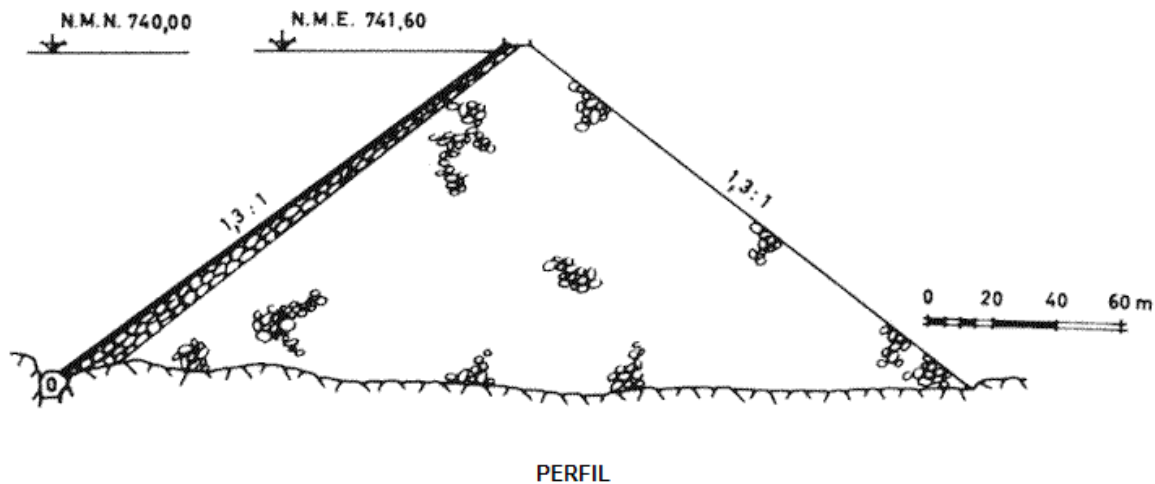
Barragem de Paradela – Perfil [4]
